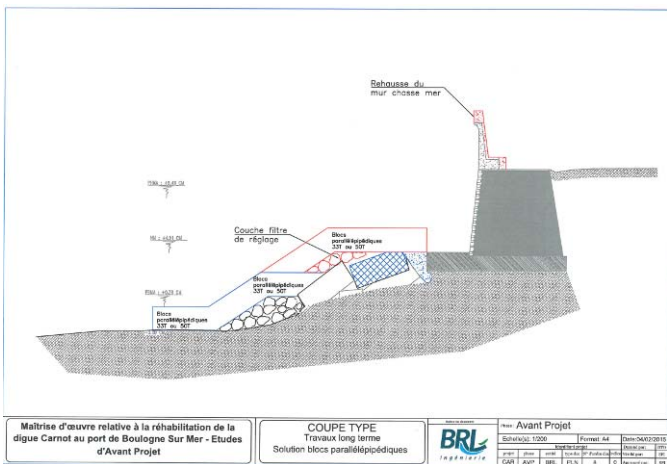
COUPE DE PRINCIPE DES TRAVAUX LONG TERME - SOURCE : BRLINGENIERIE
